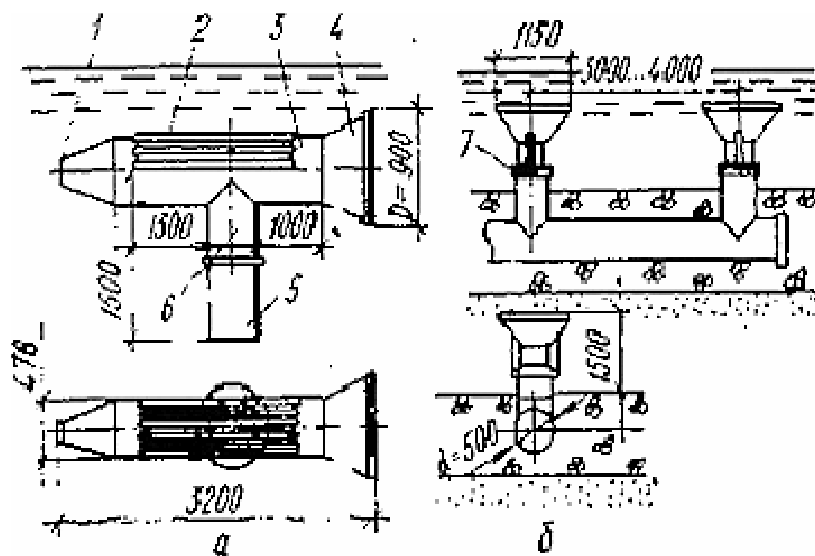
Стальные незащищенные оголовки: а – трубчатый; б – тарельчатый; 1 – заглушка, 2 – сороудерживающая решетка; 3 – водоприемная труба; 4 – приемный раструб; 5 – вертикальный патрубок; 6 – врезной соединительный патрубок; 7 – фланец
